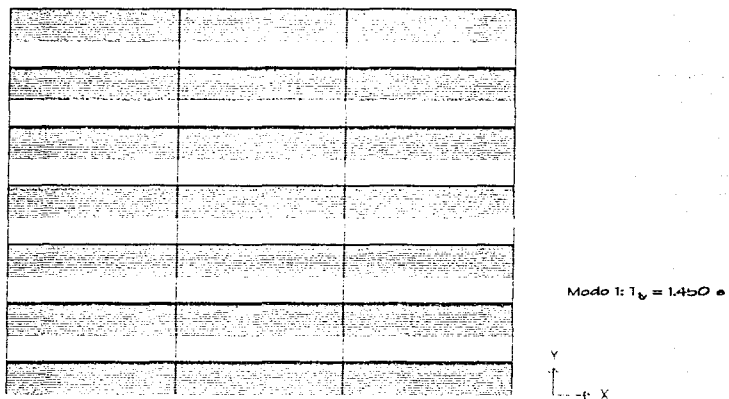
Vista en planta del modo fundamental de vibración de la dirección "Y", estructura de 17 niveles diseñada en la zona III
